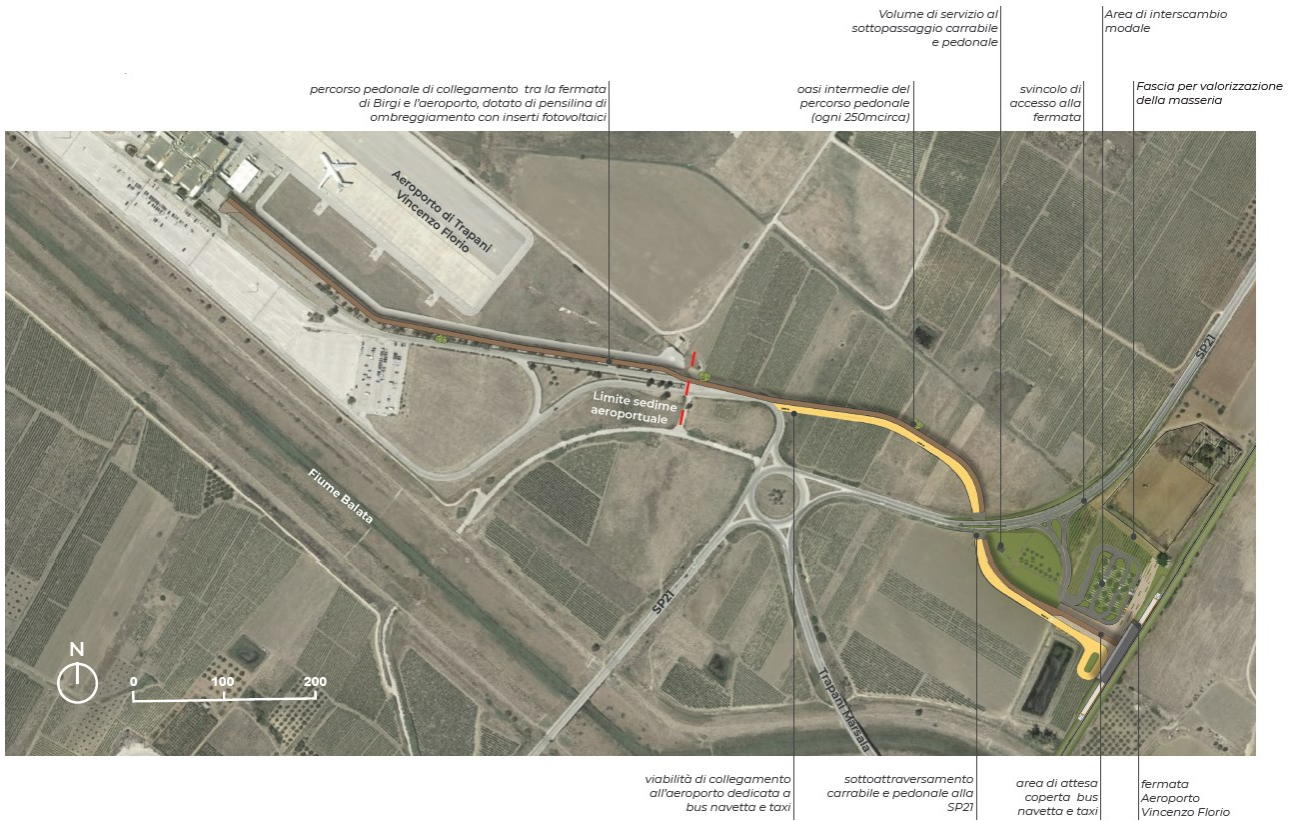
Planimetria generale dell'area di intervento. Situazione post operam. Fonte "Book soluzioni architettoniche" allegato alla Lista di controllo.
